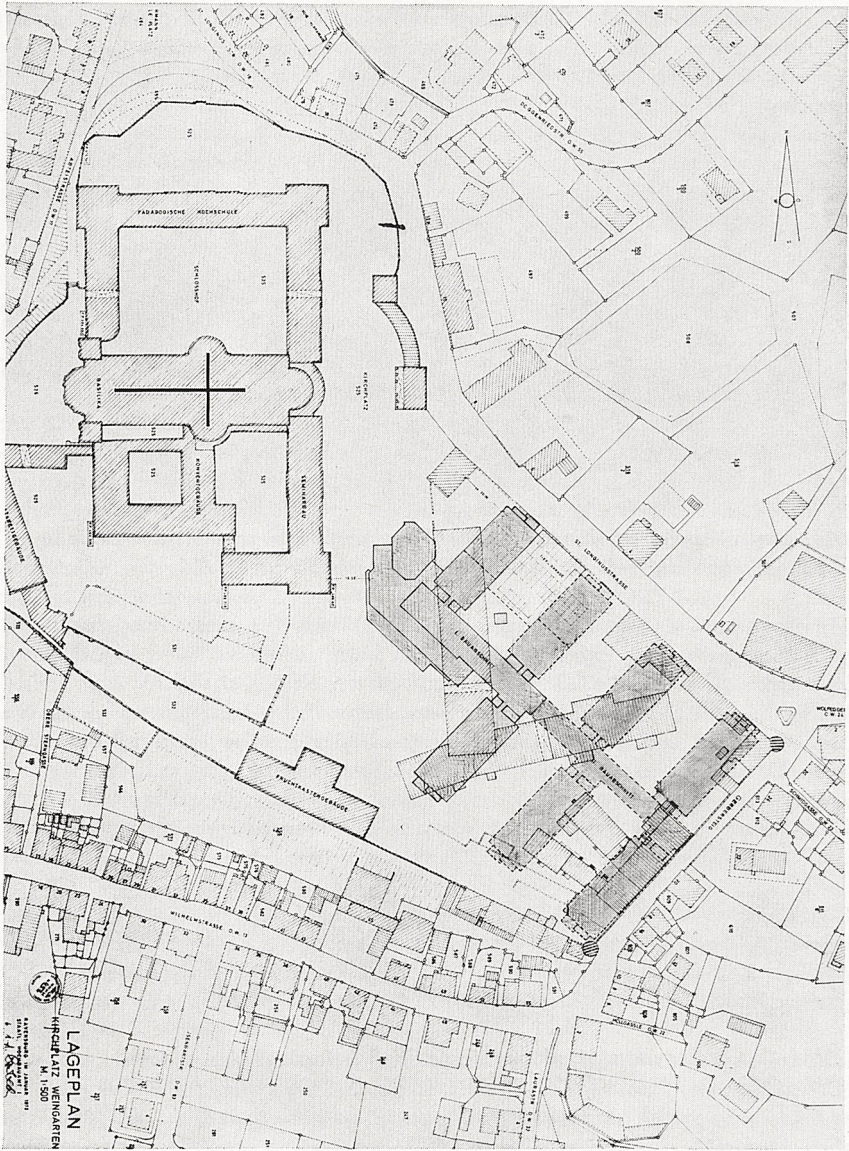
Weingarten, Lageplan der Klosteranlage mit dem (dunkel getönten) Neubauprojekt der PH. Die darunter erkennbaren schraffierten Grundrisse bezeichnen die inzwischen bereits niedergelegten Vorgängerbauten
